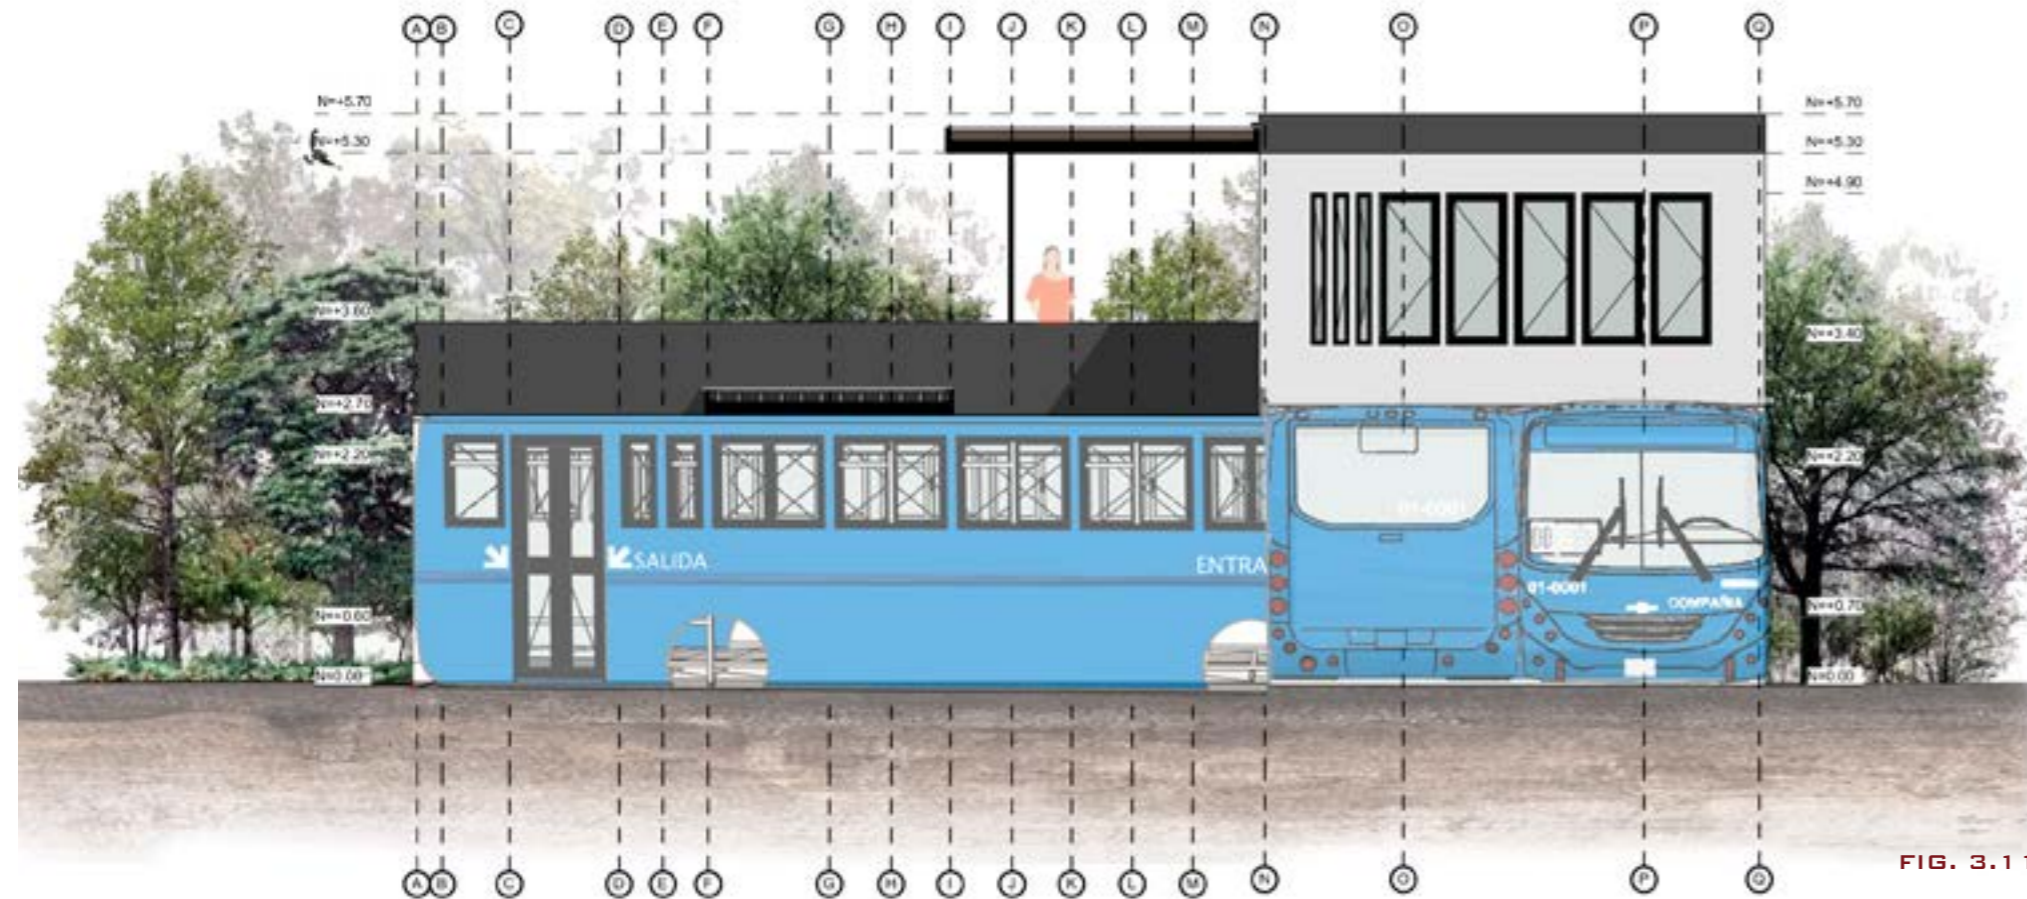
Imágen_ Fachada Frontal de Ubicación de Carrocería
